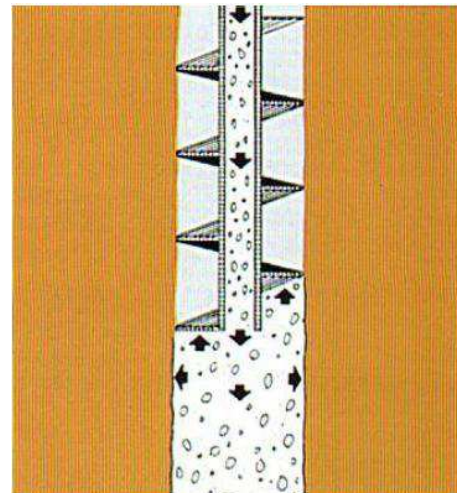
Dettaglio del getto e contemporanea risalita dell'elica
